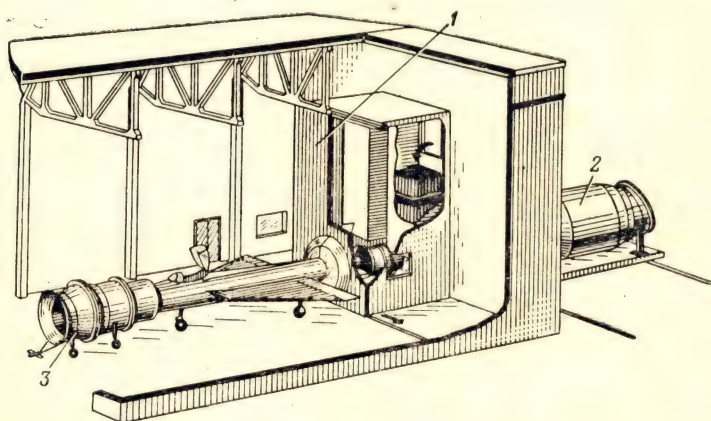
Шумоглушающее устройство для корпуса подготовки самолетов к полетам:
